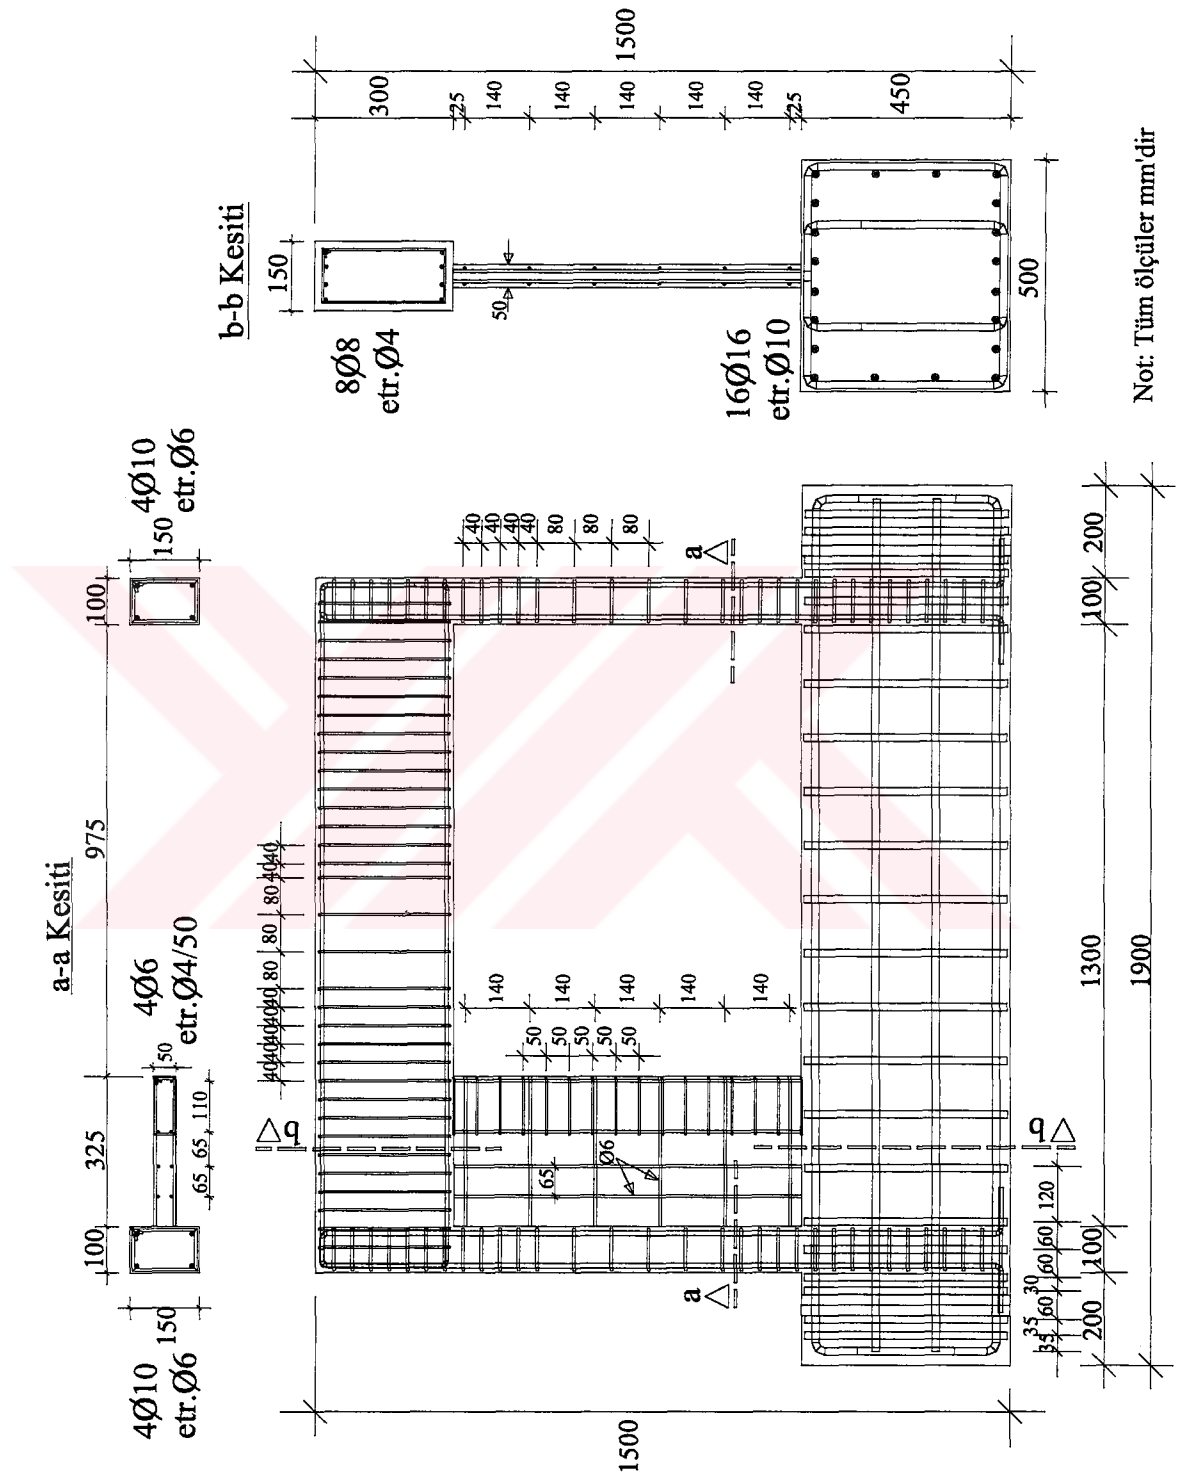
Deney Elemanı-1'in donatı detayı
